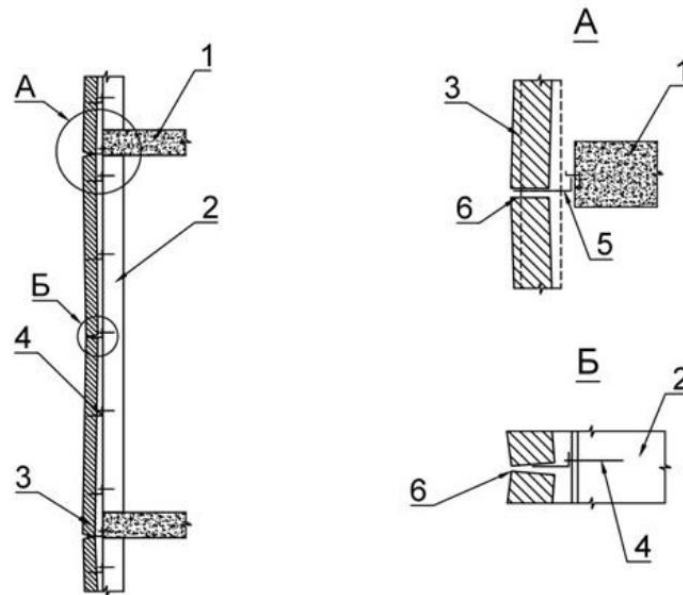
Схема деформирования лицевого слоя, опирающегося на металлические уголки: 1 – плита перекрытия, 2 – внутренний слой, 3 – лицевой кирпичный слой, 4 – горизонтальные анкеры, 5 – опорный уголок, 6 – трещина [23]
